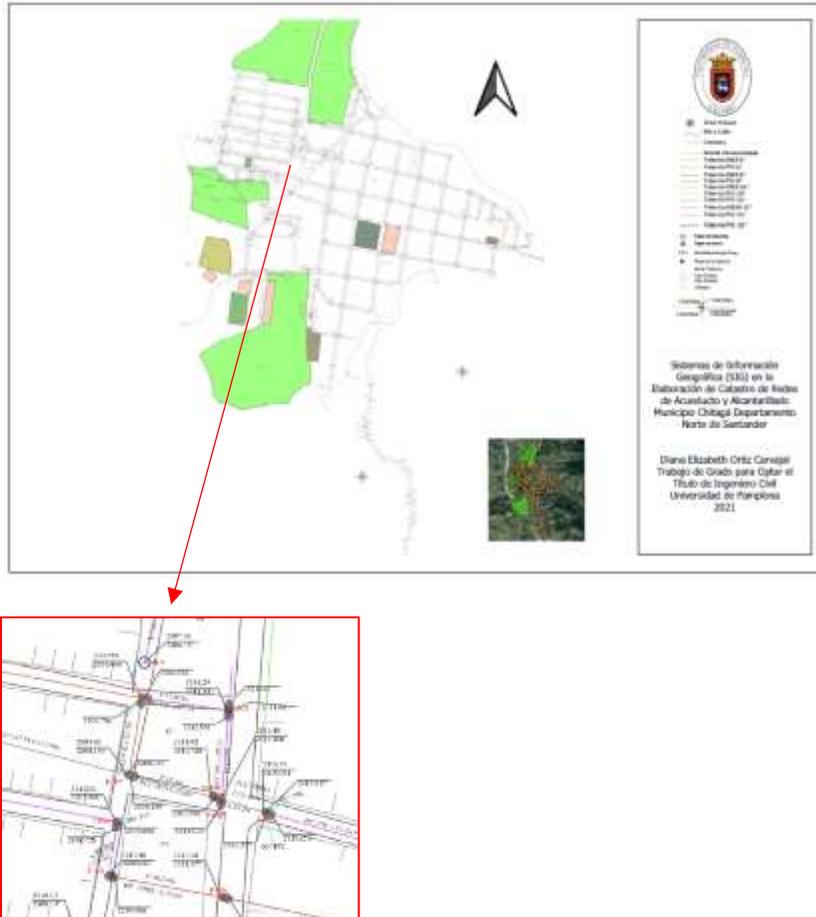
Plano SIG QGIS Sistema de Alcantarillado
